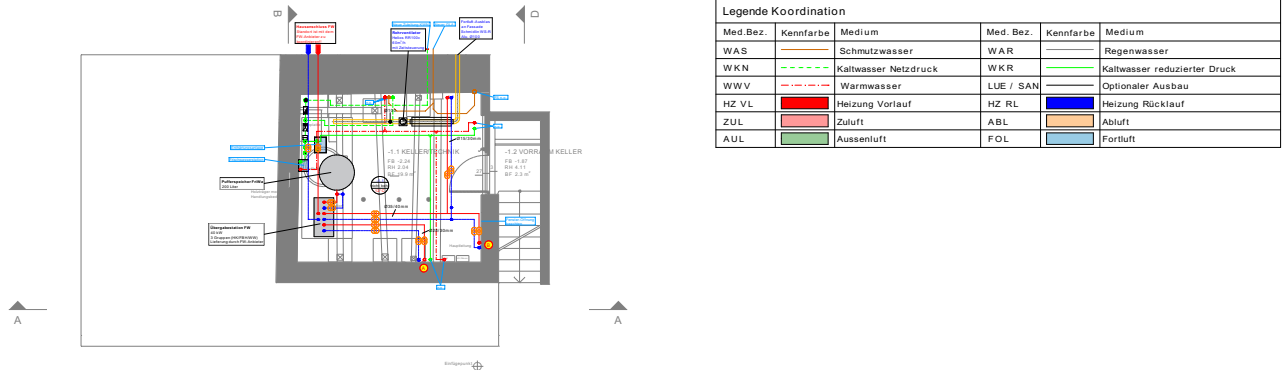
Grundriss UG Koordinationspläne
